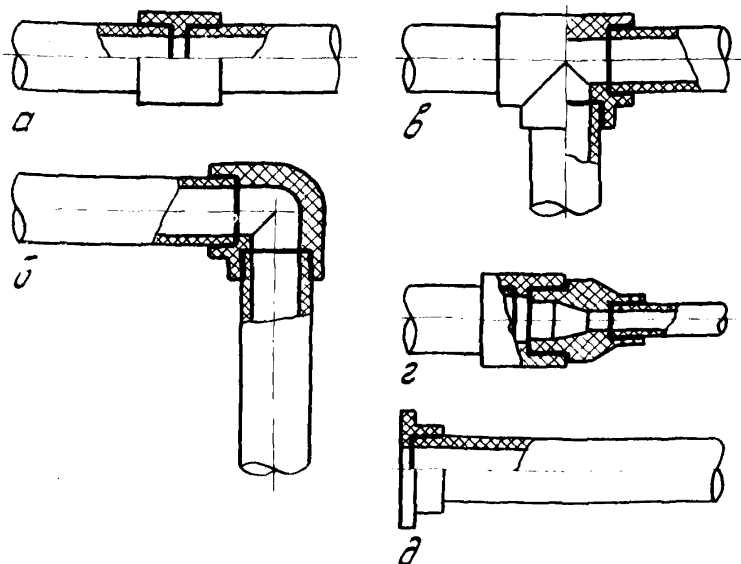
Сварные раструбно-стыковые соединения труб и соединительных деталей из ПВД:
